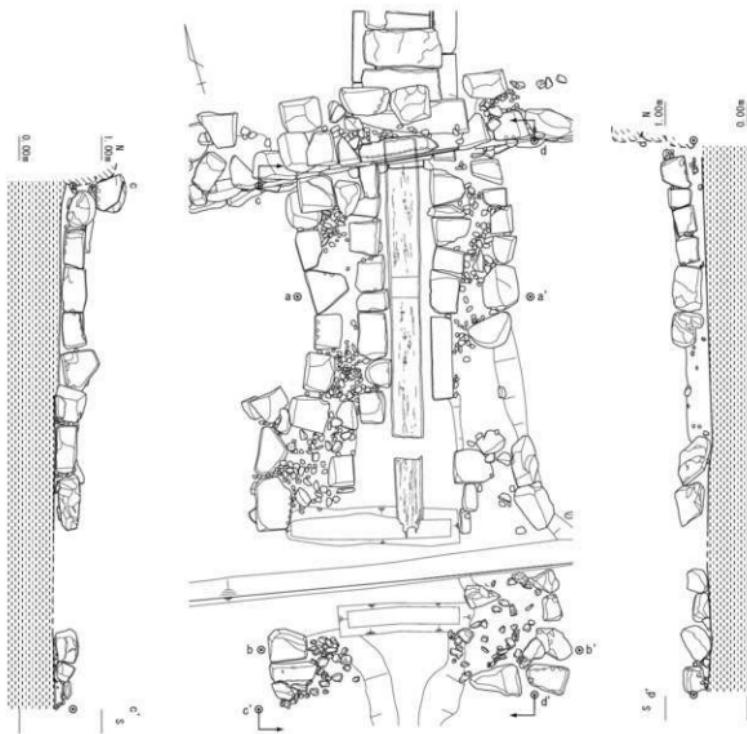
漏水施設 平面図・断面図 (1/100, 1/40)
